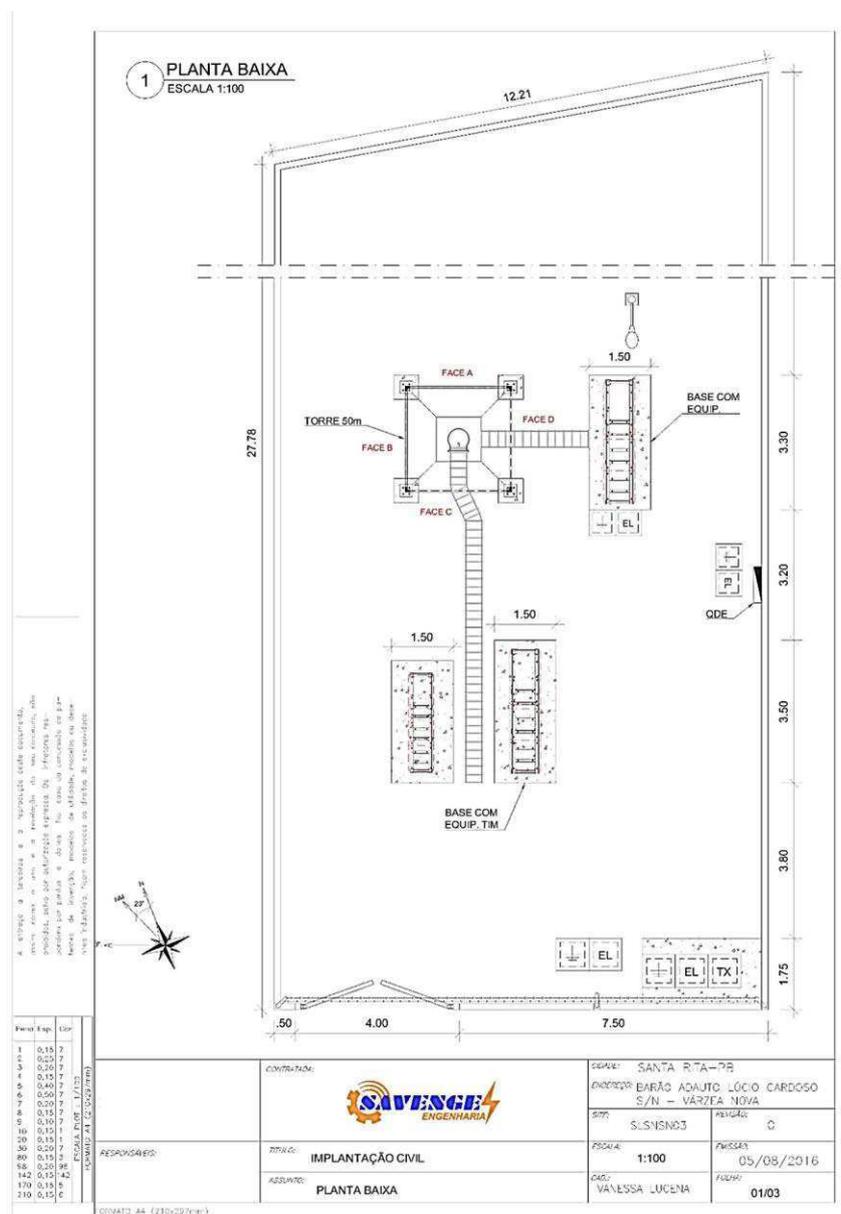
SEGUNDA FOLHA DO AS BUILT, PLANTA BAIXA, DO SITE SLSNSN03.
